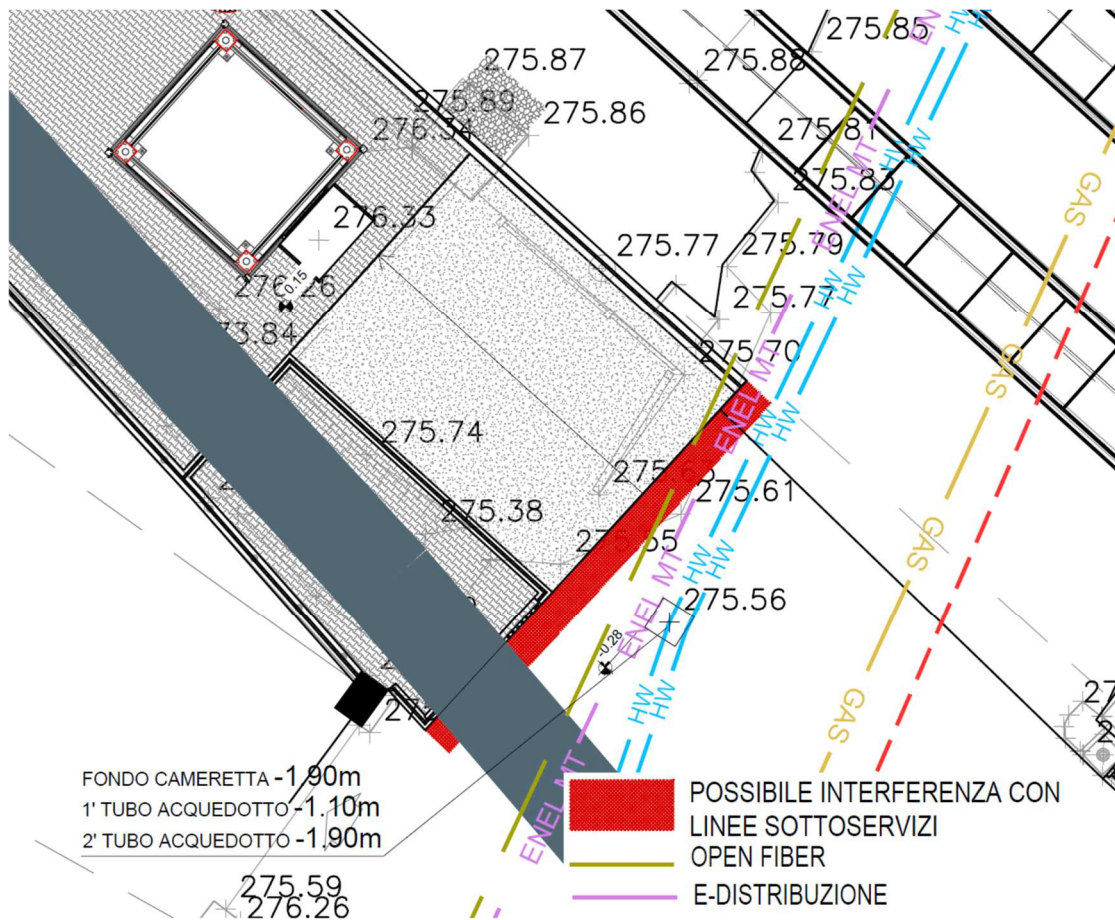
Estratto planimetria F30Dh001SR--R0 con evidenza della zona di possibile interferenza (lato via Piave)
